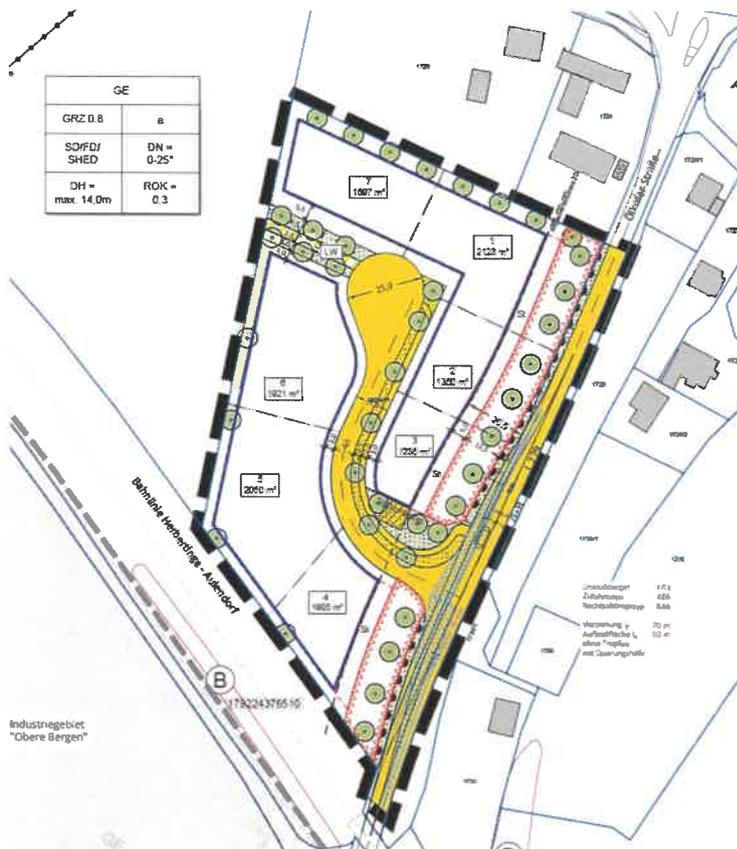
Bebauungsplan „An der Ölkofer Straße“, Planzeichnung Quelle: Lars Consult, Planungsstand April 2021
